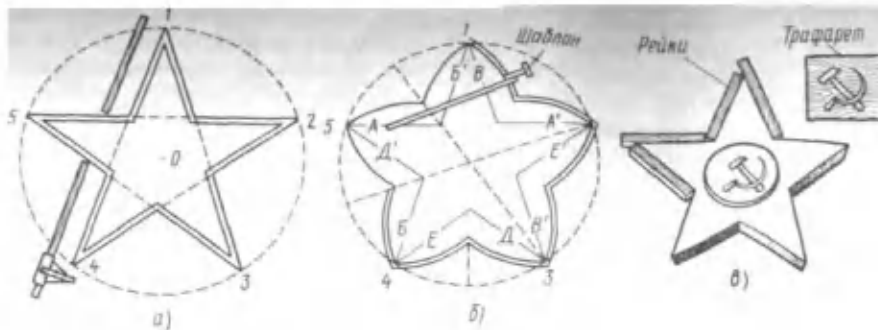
Вытягивание (а, б) и изготовление (в) звезды: а — с прямыми концами, б — с закругленными
